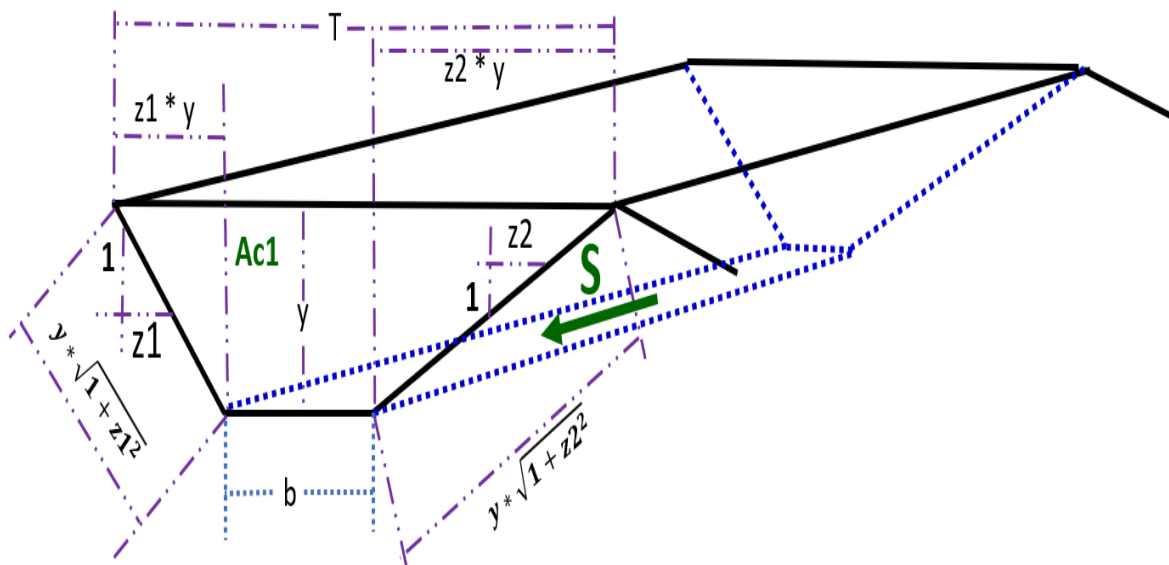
Sección transversal de un canal trapezoidal donde se tienen diferentes taludes “ $z_1 \neq z_2$ ”
